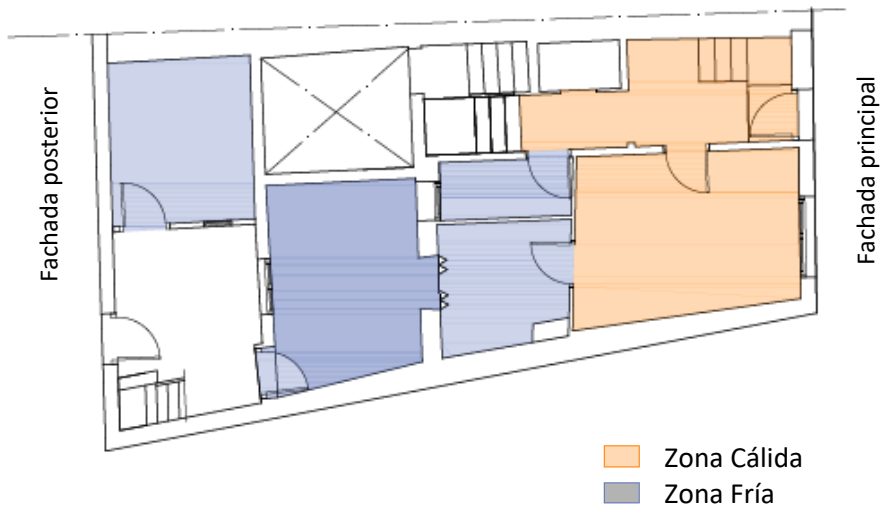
Diferenciación de Zonas. Planta Baja. Fuente Propia.
